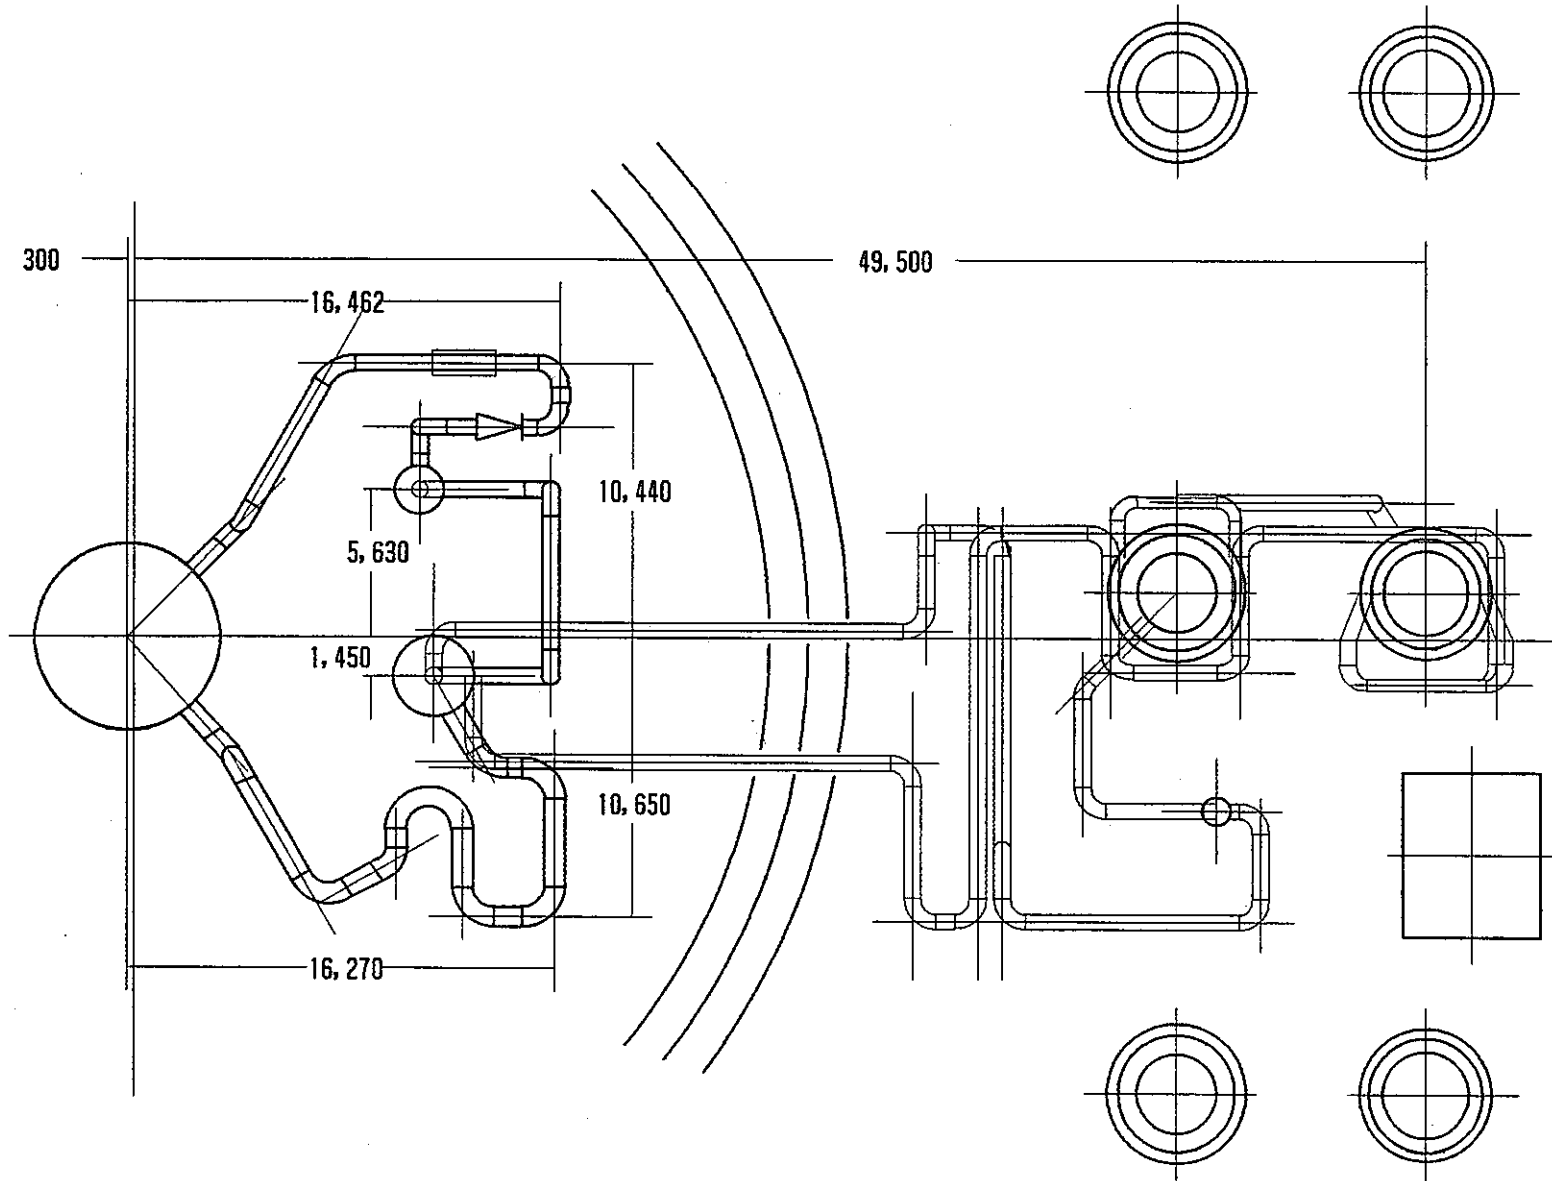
もんじゅ主冷却系統平面図 (Bループ)
